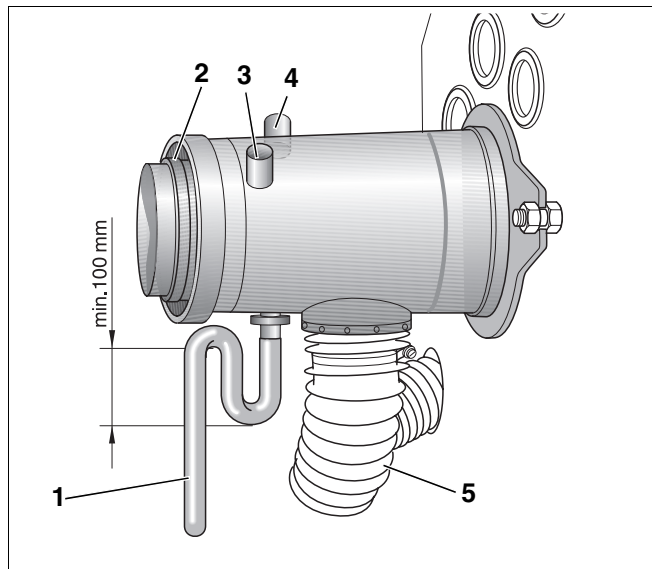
Соединительный штуцер концентрической дымовой трубы
